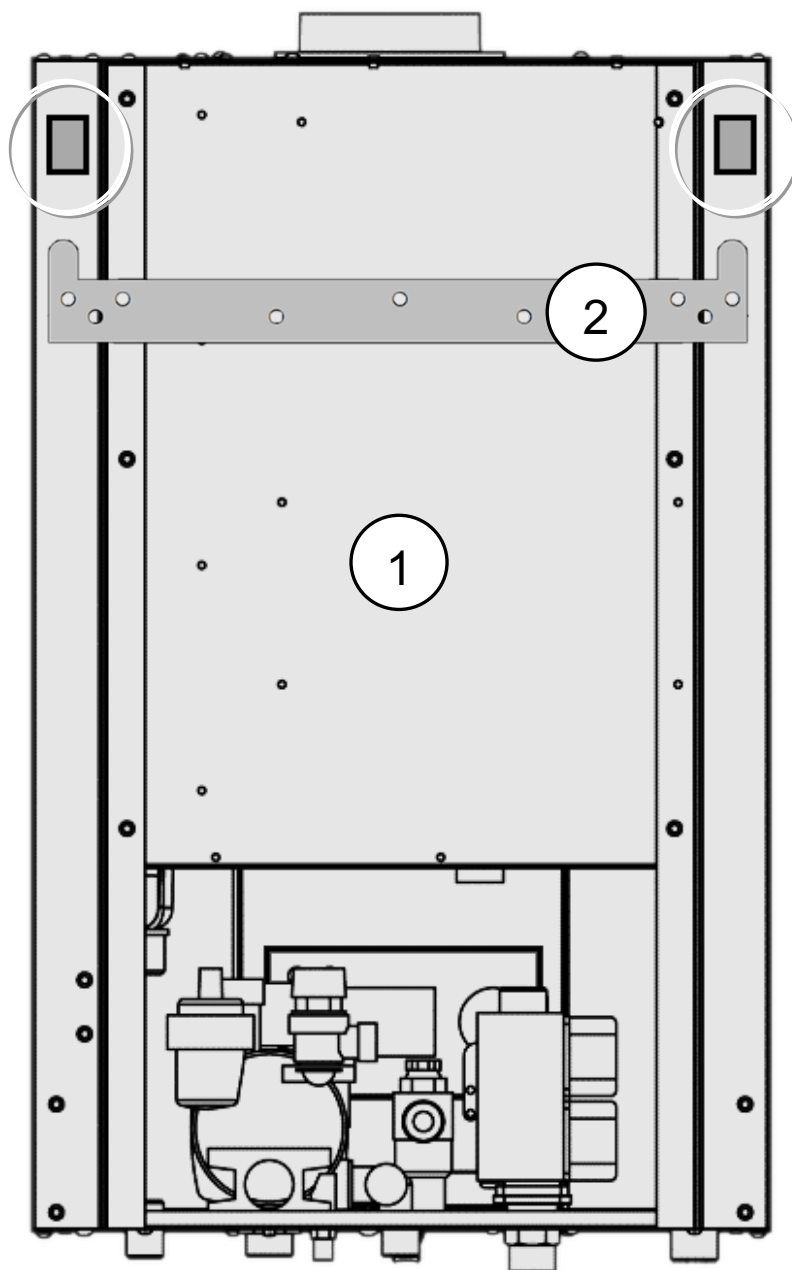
Монтажная планка (кронштейн крепления котла на стене).
